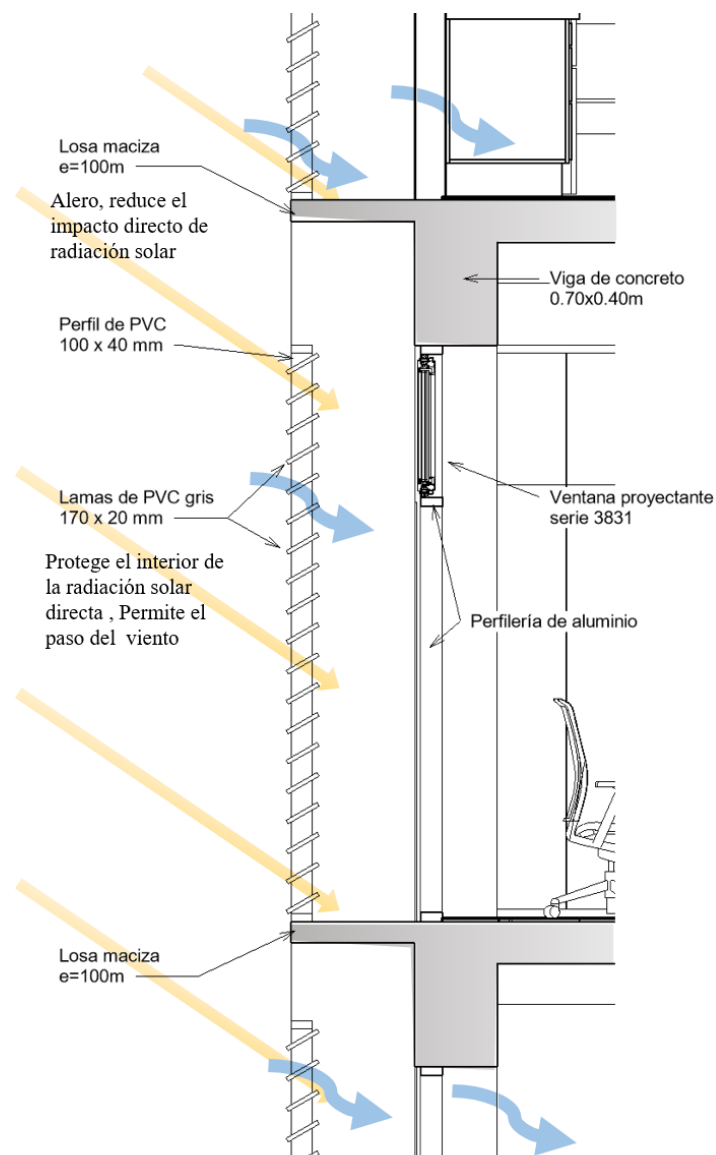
Esquema de celosía fija para oficinas en la fachada oeste.
